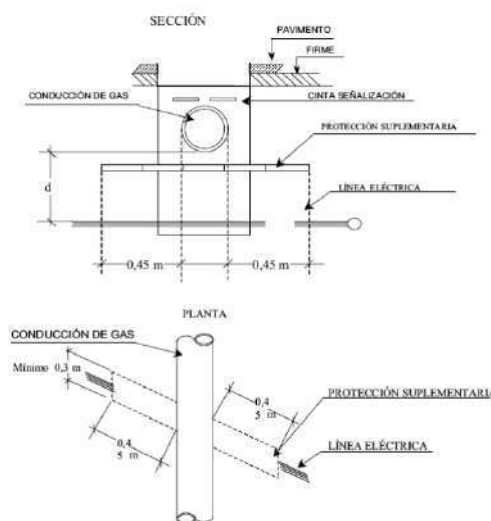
Detalles de cruzamiento y conducciones (ITC-LAT 06)
